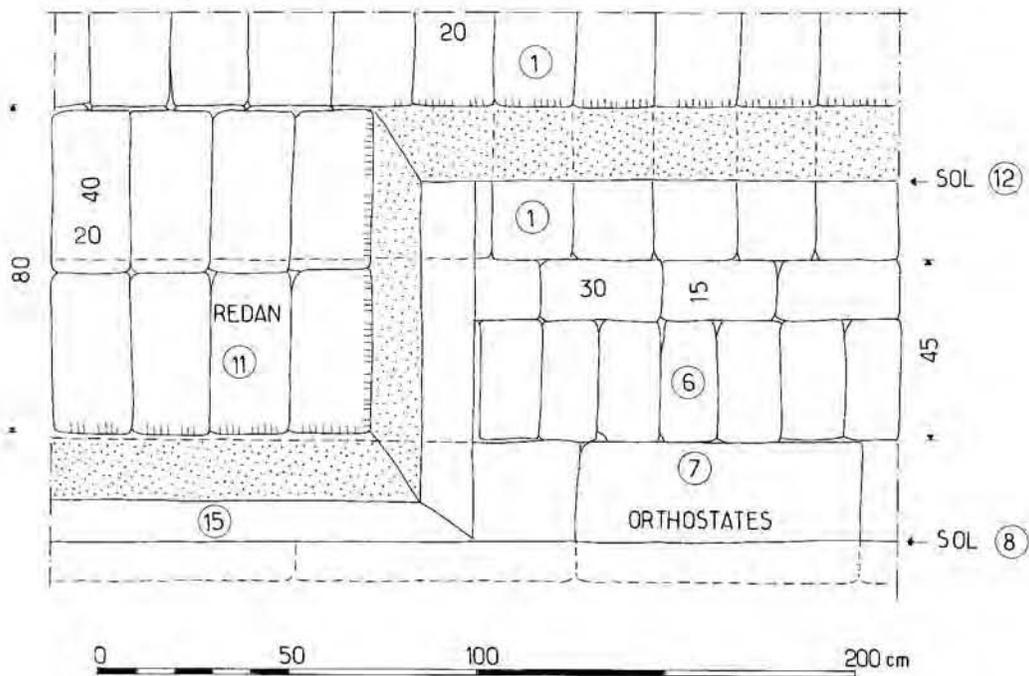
Angle nord du premier redan, plan de l'appareil (numéros cerclés même légende).
